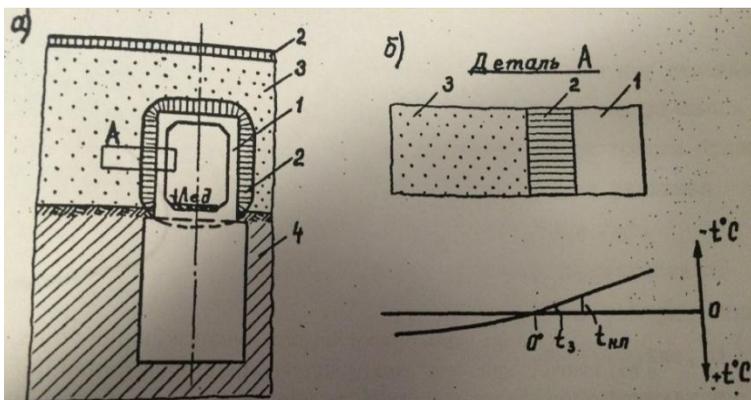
схема расположения талых и мерзлых слоев грунта в период, когда прилегающий к секции слой грунта находится на стадии начального промерзания
